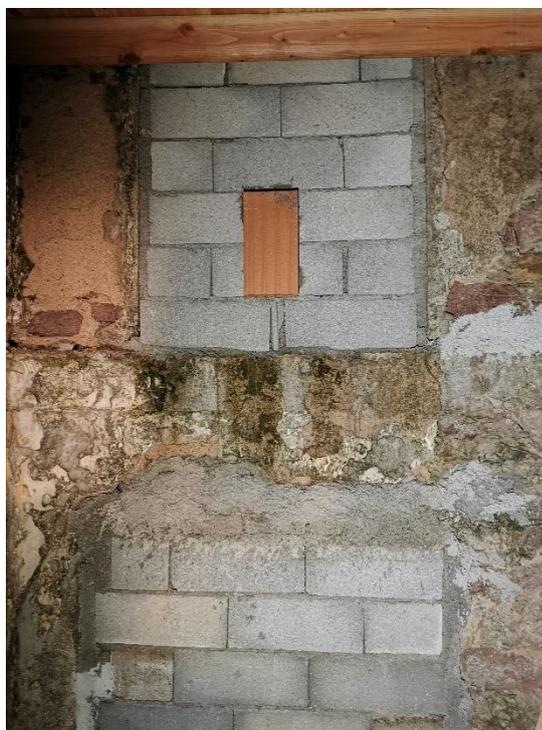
MUR DU FOND DE LA CAGE D'ESCALIER RENFORCE PAR BANCHAGE
